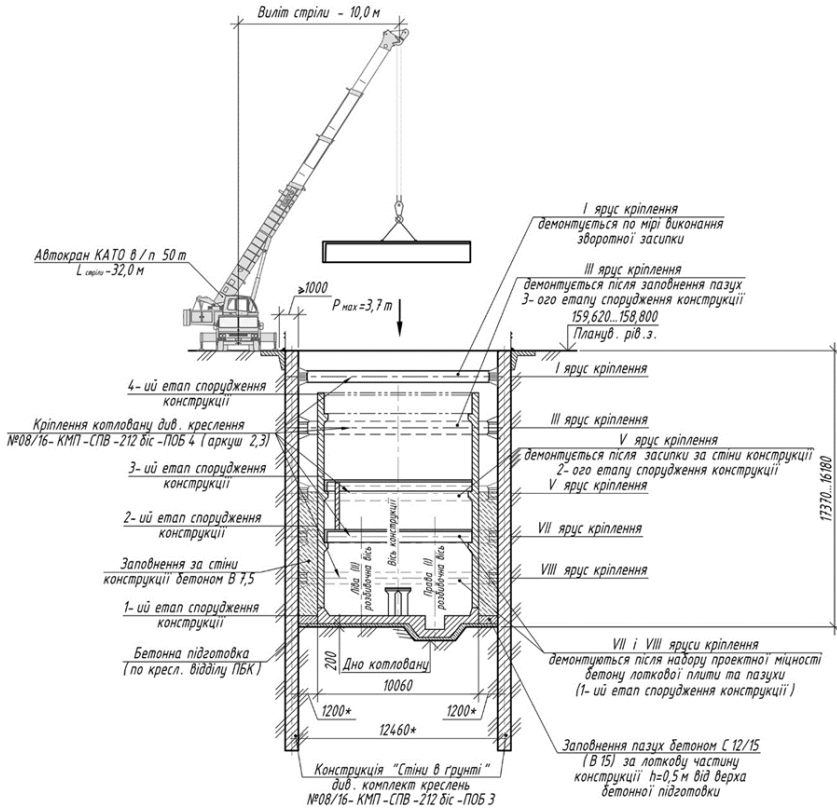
Конструктивна схема котловану в межах впливу на будівлю по просп. Правди 68а при монтажі конструкцій тунелів
